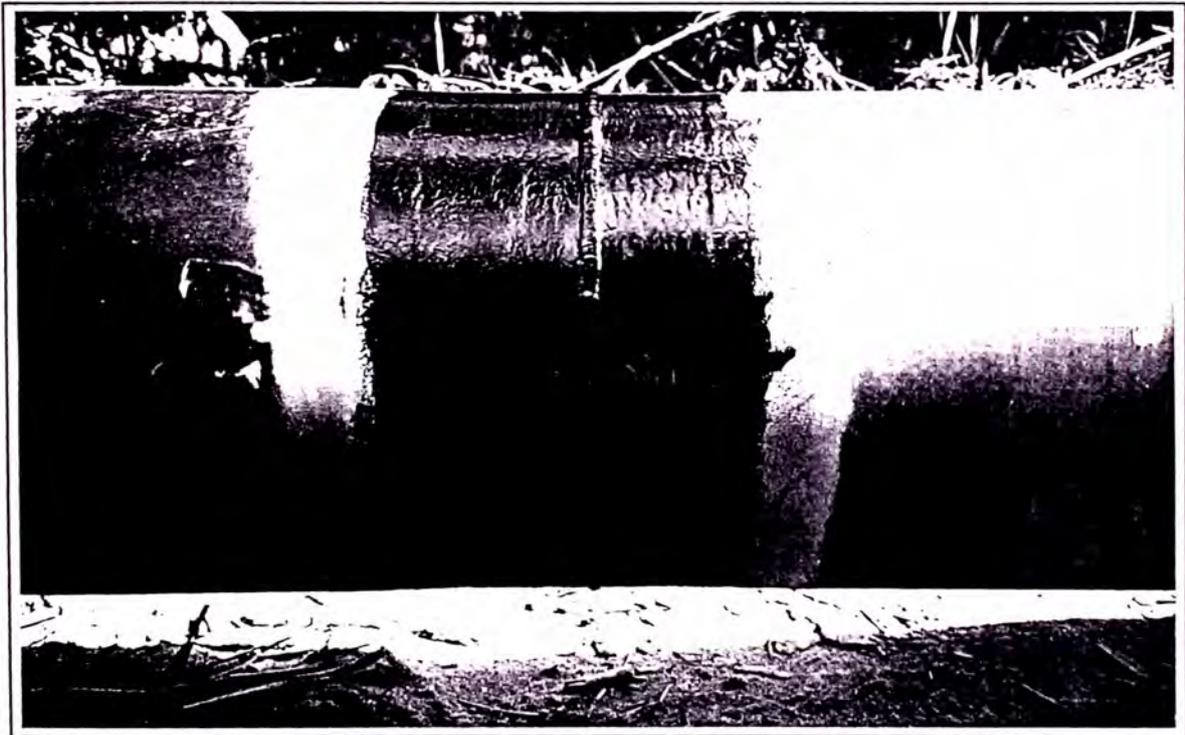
Powercrete aplicado en dos pases para cubrir el espesor.
